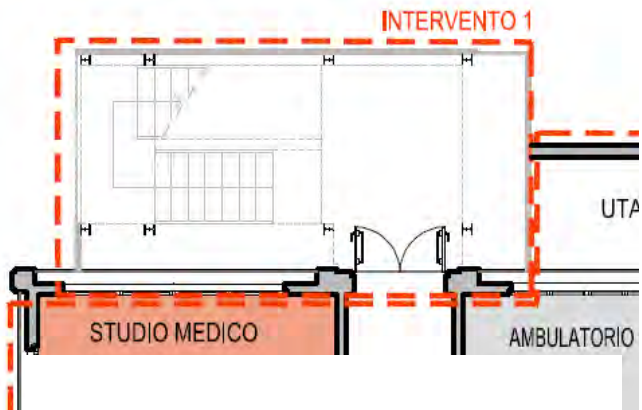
Individuazione intervento 1 – ipotesi progetto
